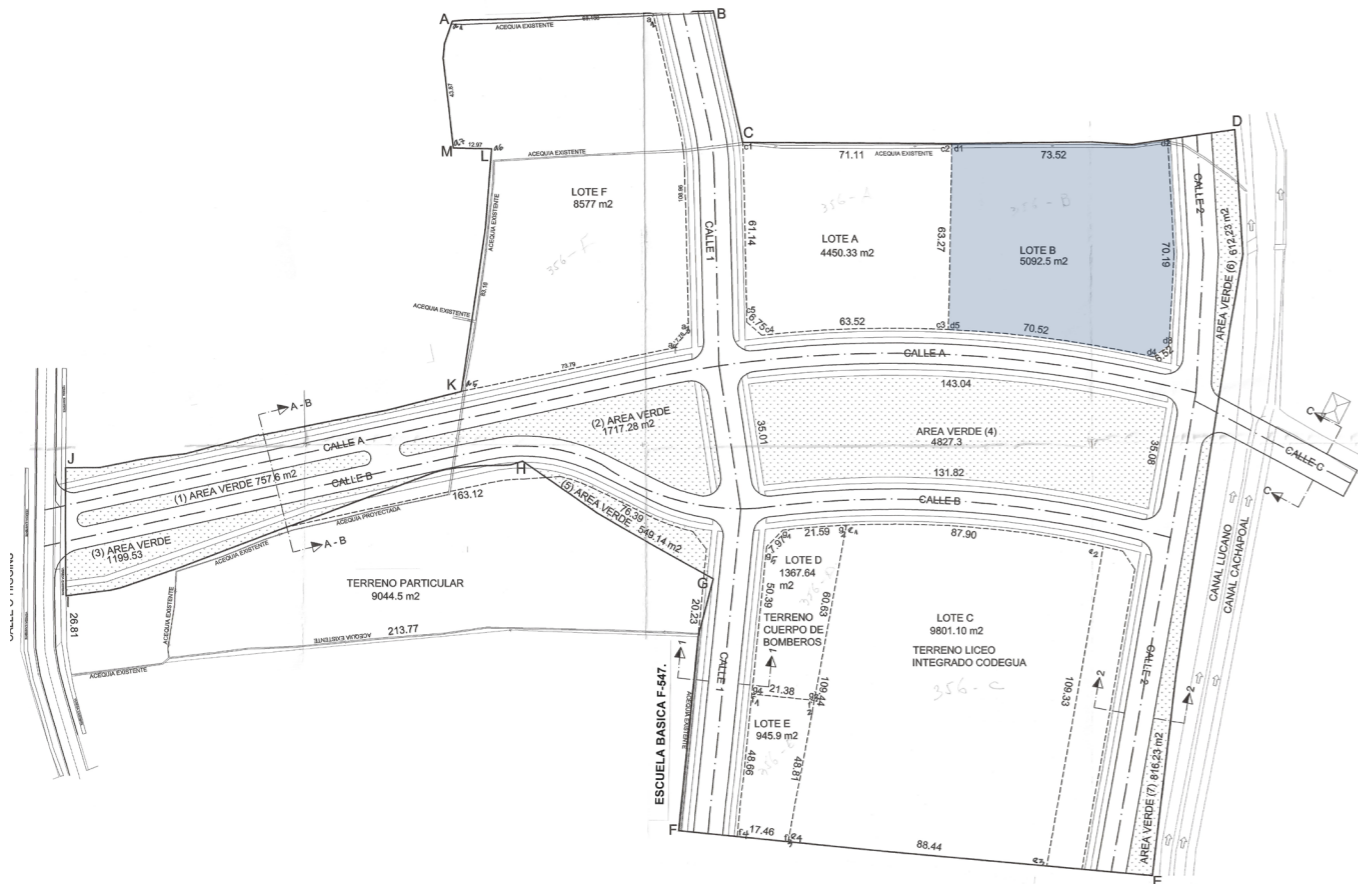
Planos originales proyecto barrio cívico - Facilitados por SECPLA, Codegua.
